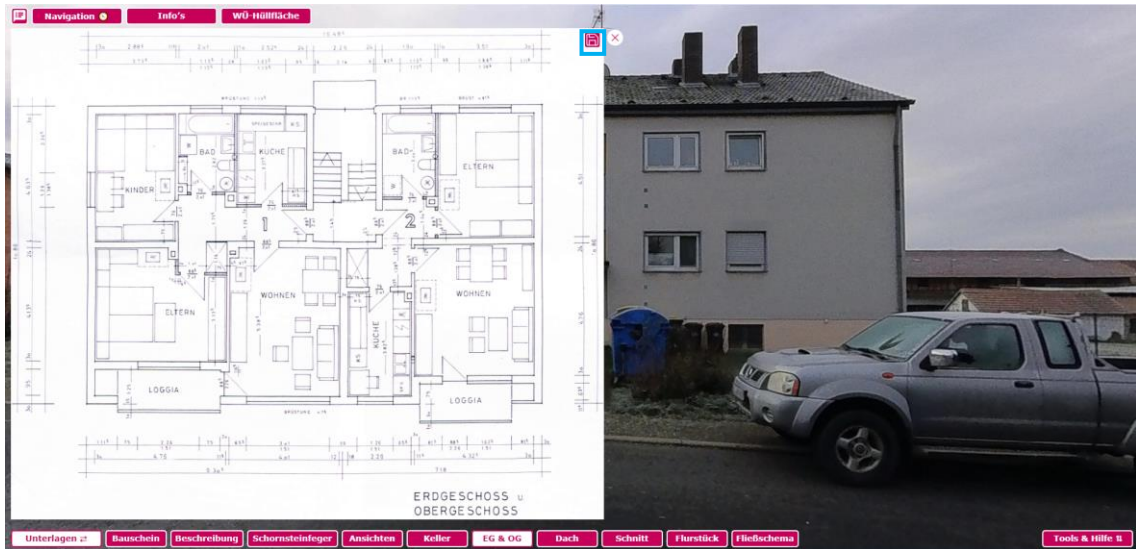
Beispiel Unterlagen anhand von einem Geschossgrundriss
